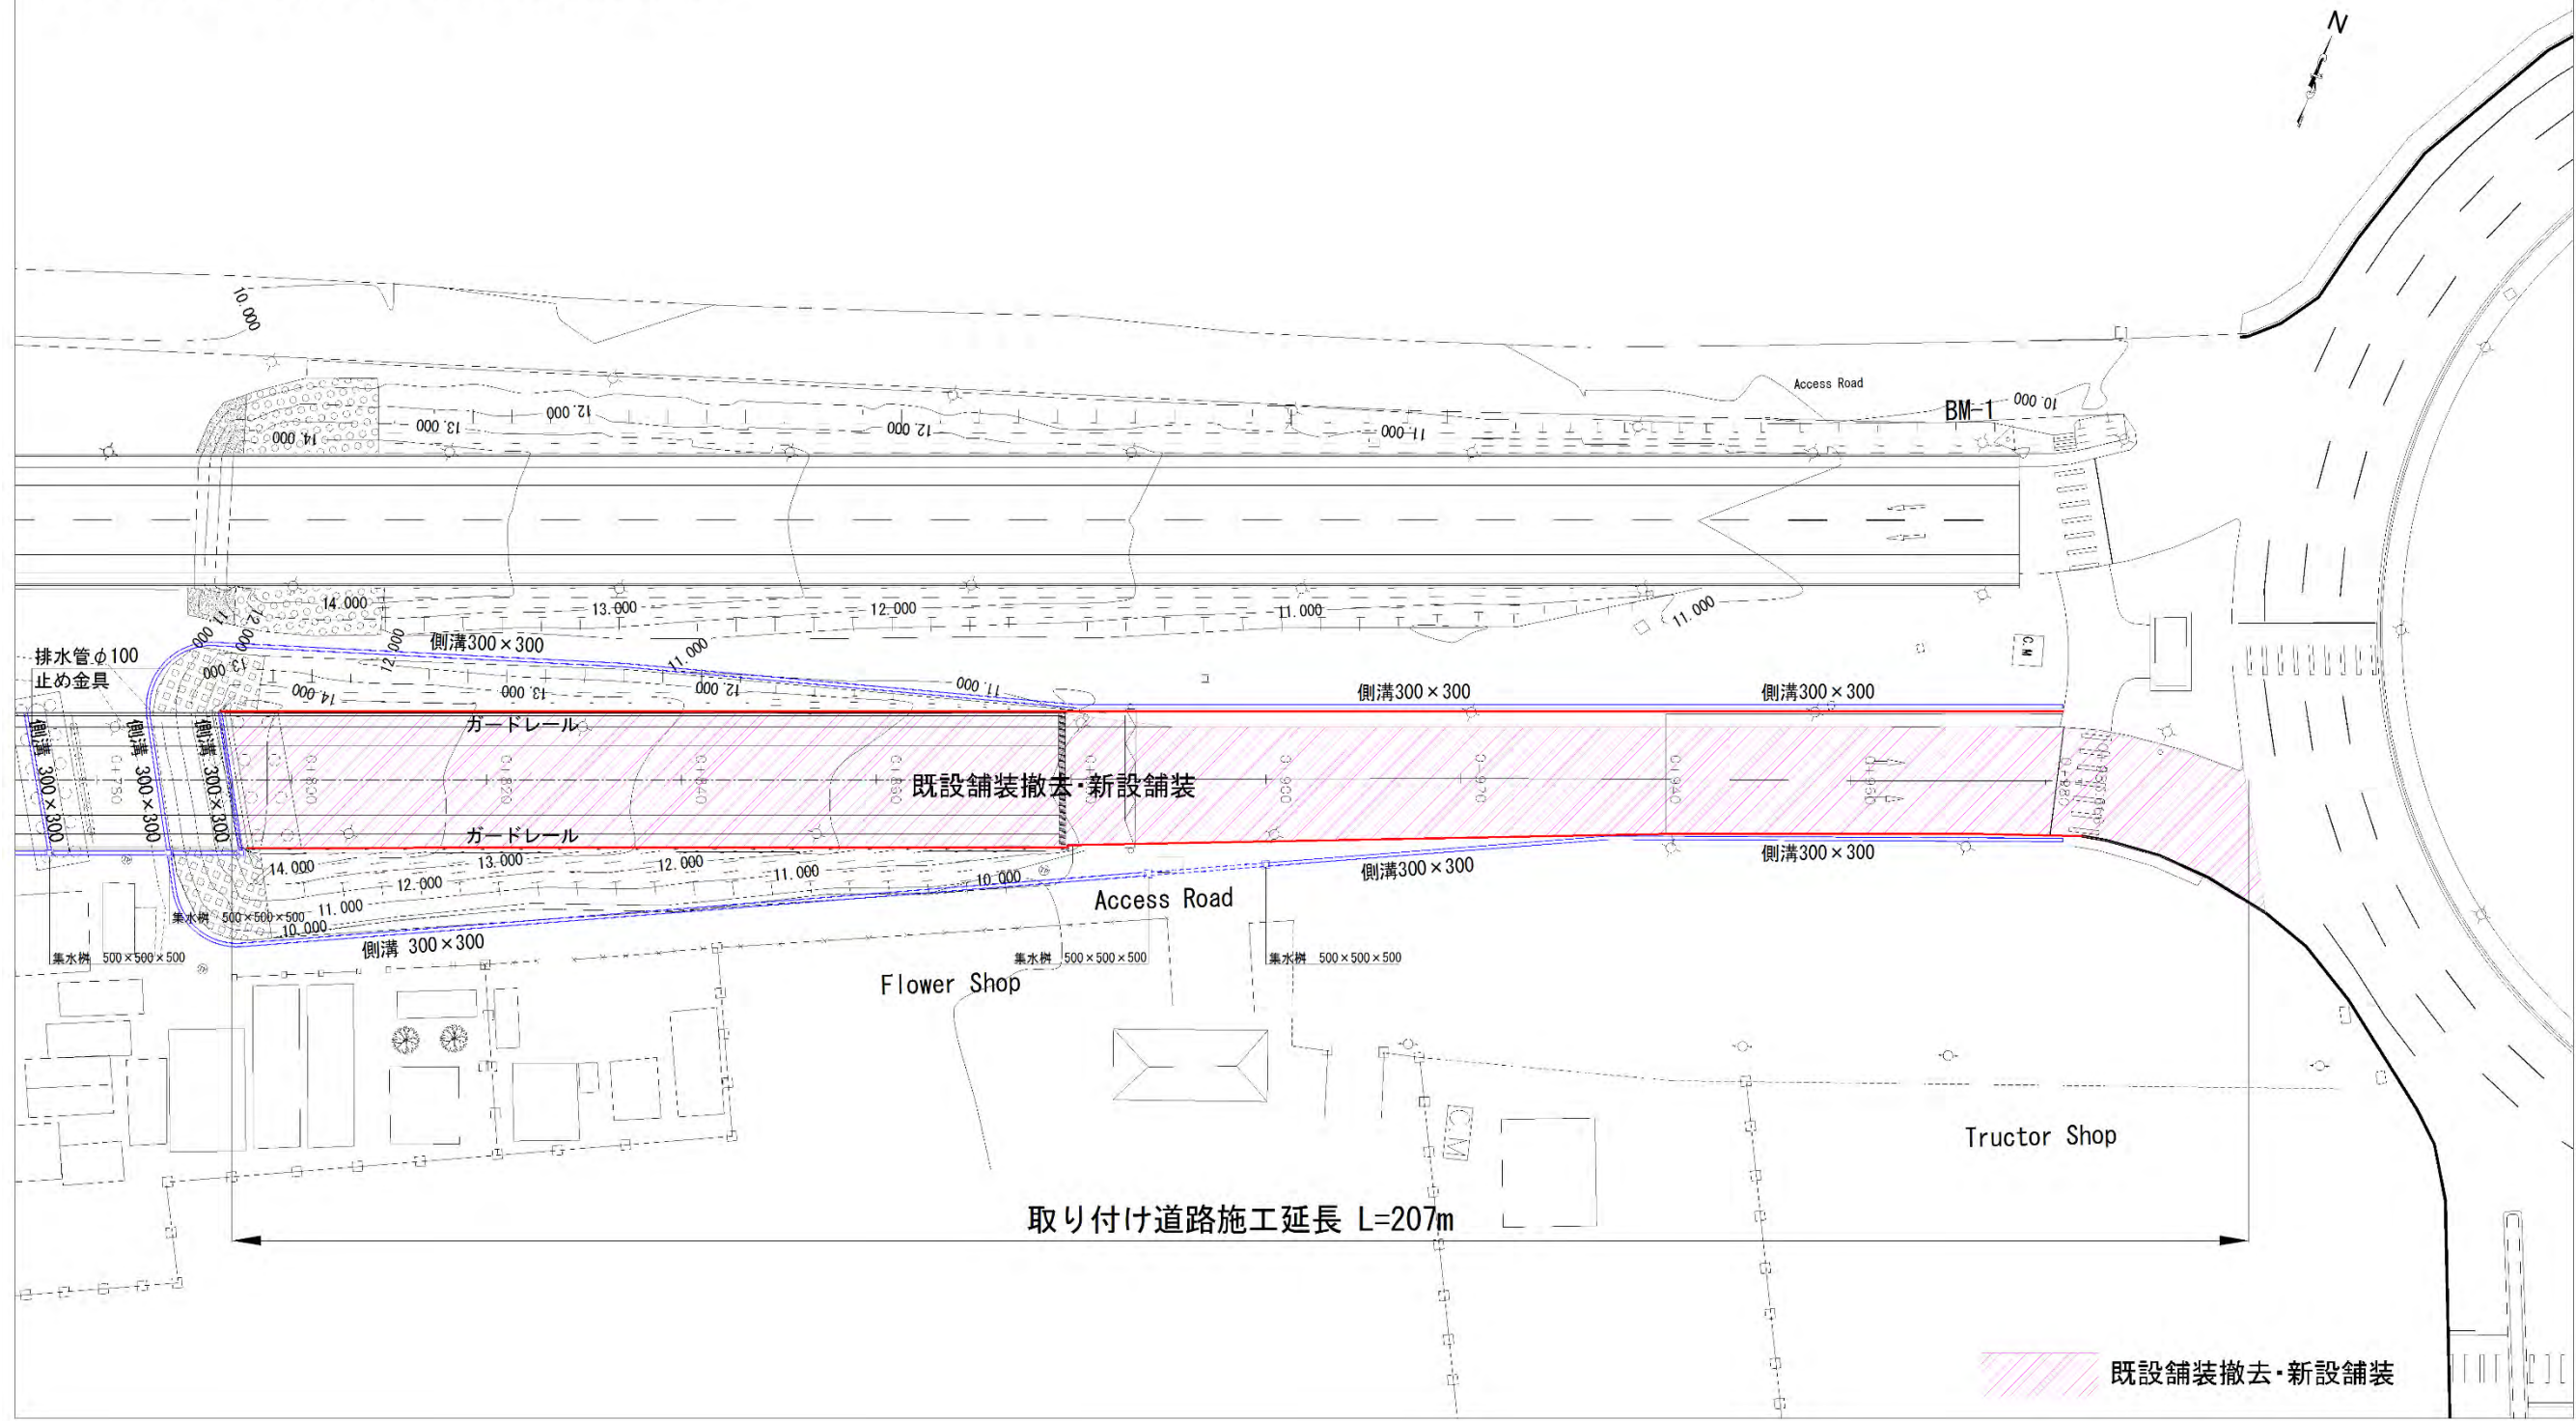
取付道路平面図 (チュルイ・チョンバー側)
